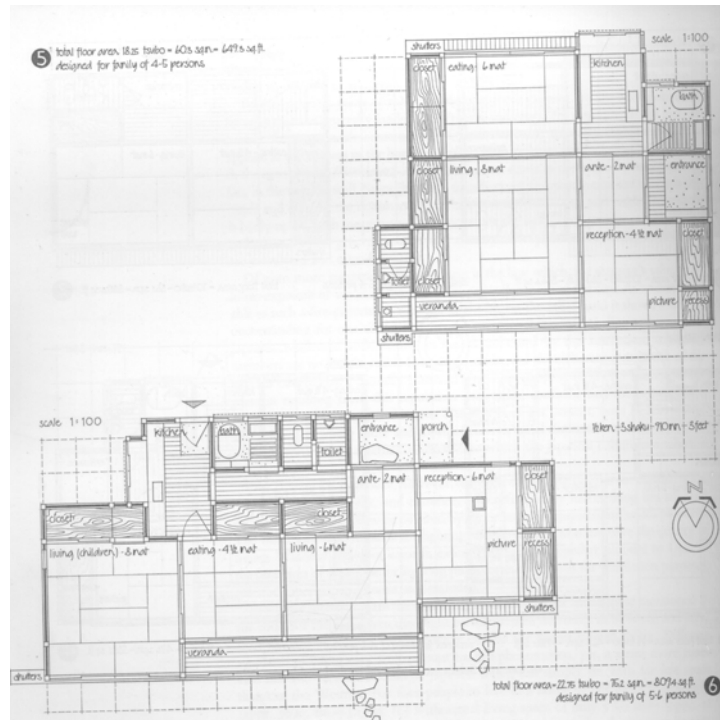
Planta – “tsubo” – casa. Fonte: Engel (1983)
